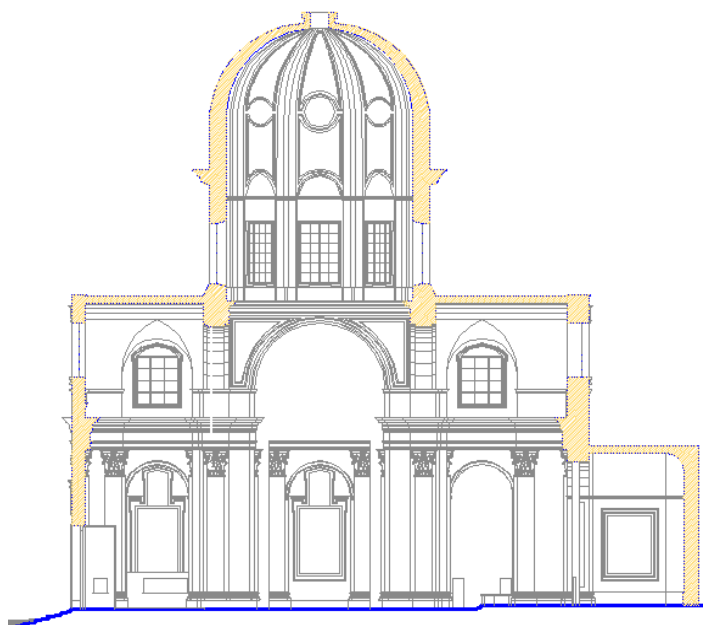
Santa Maria Maggiore della Pietrasanta. La Sezione longitudinale.
